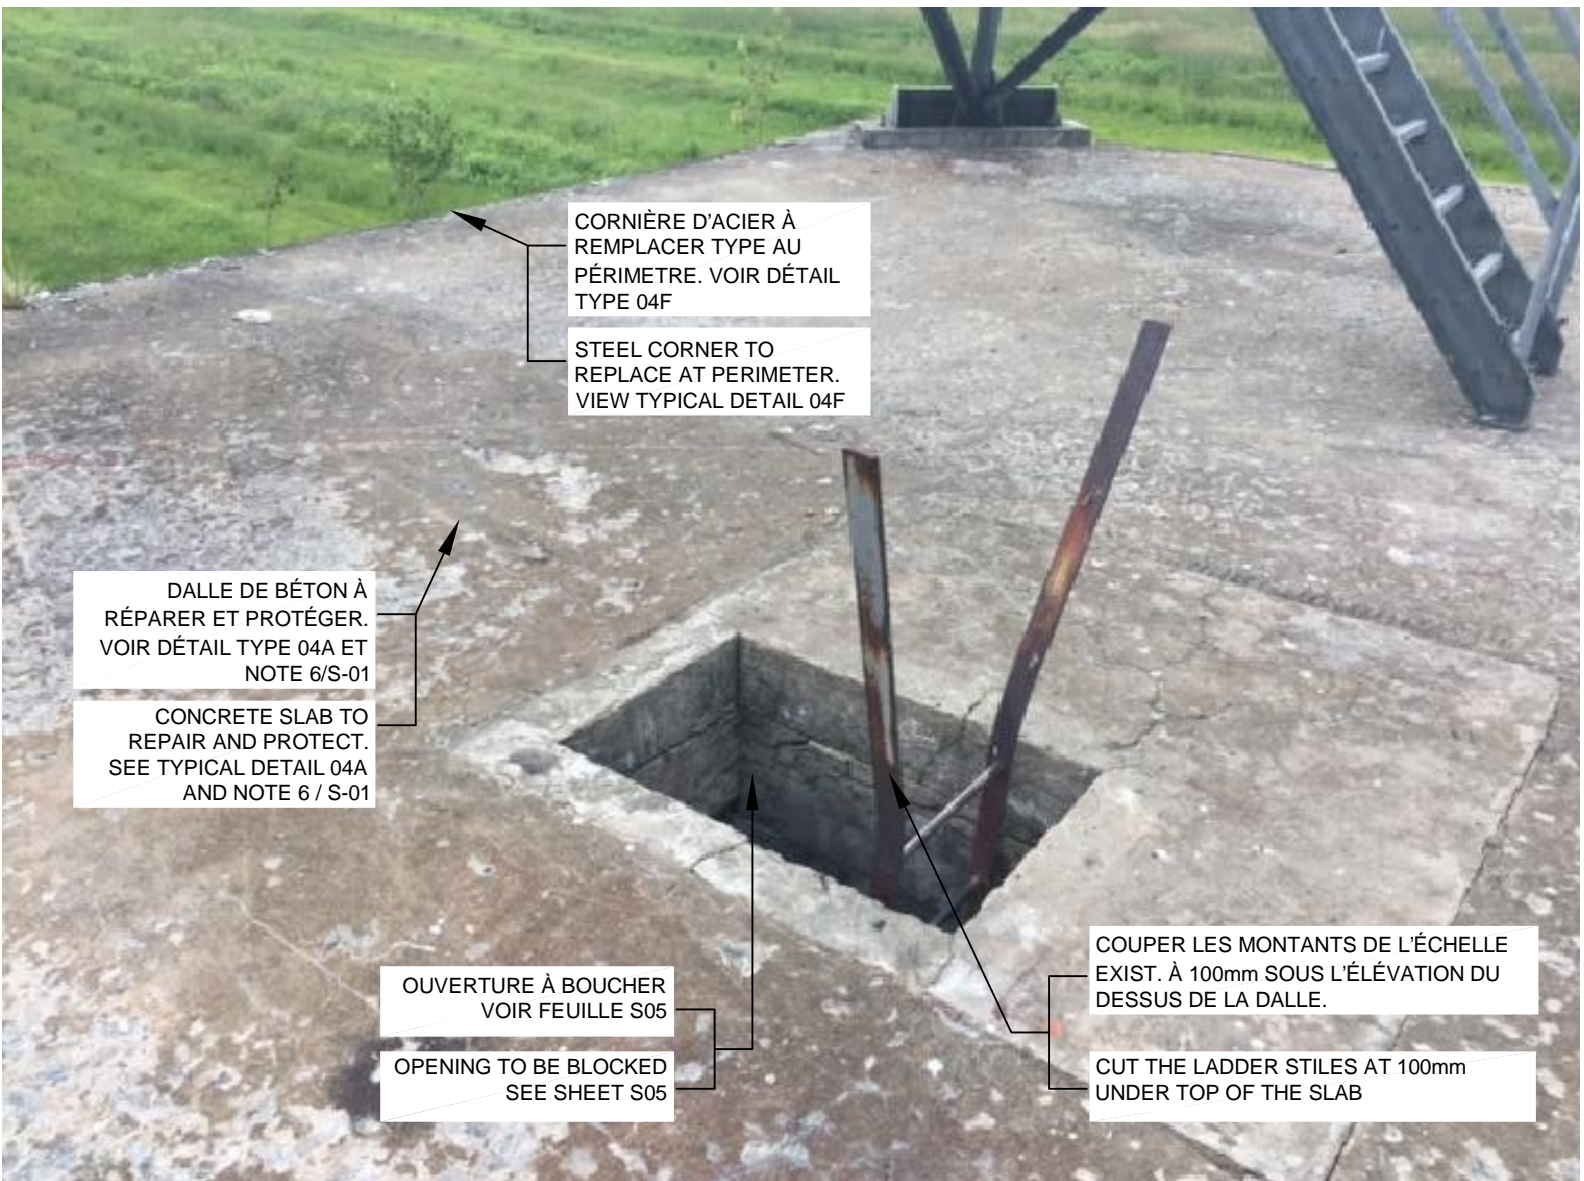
OUVERTURE EXISTANTE DALLE DE TOIT À CONSERVER /
